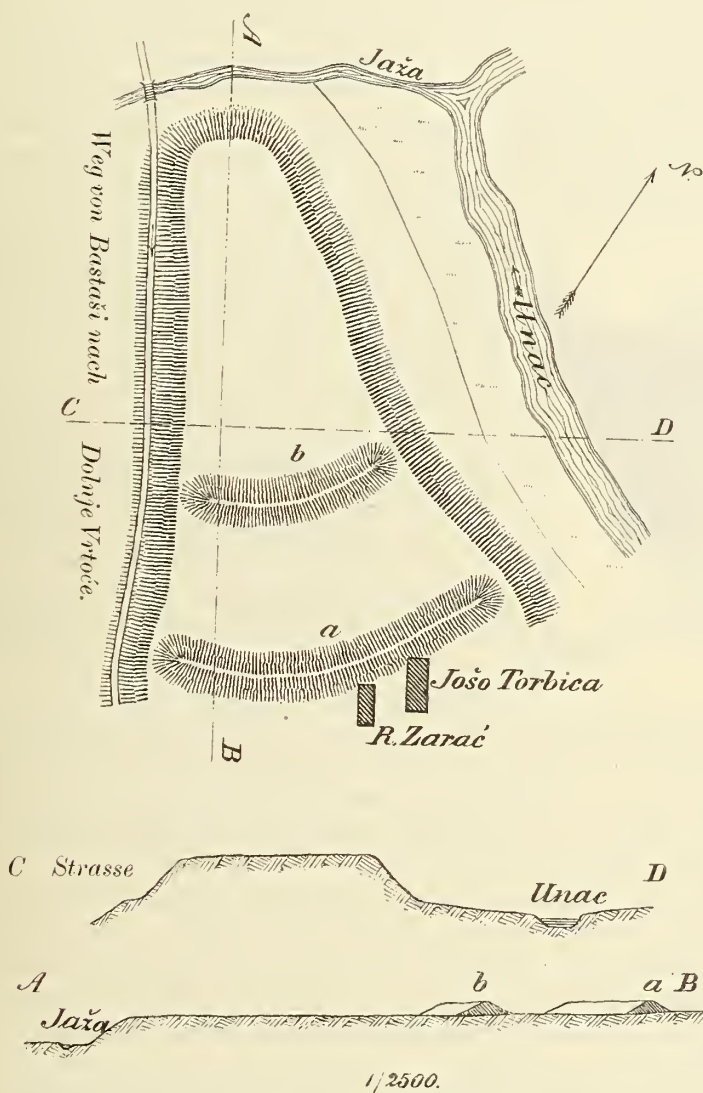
22. Grundriss und zwei Durchschnitte des Wallbaues bei Dolnje Vrtoče.
